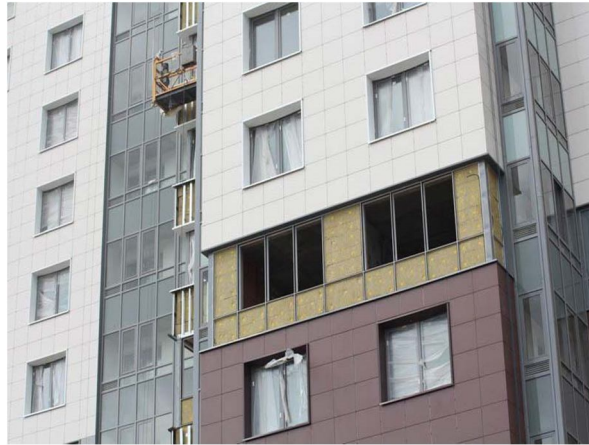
Утеплення методом вентильованого фасаду
